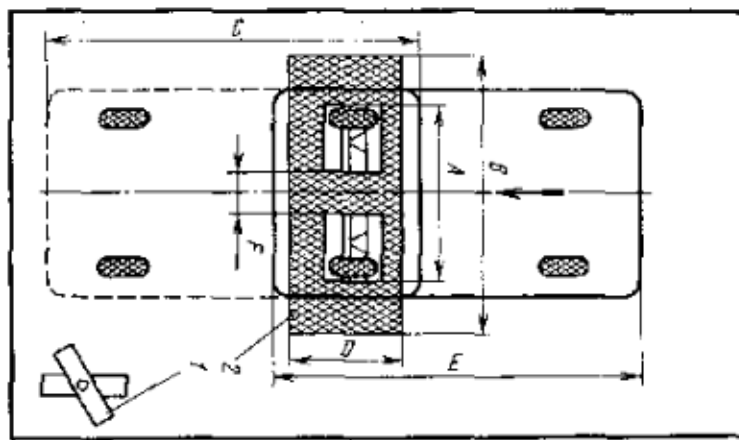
Планування майданчика із стендом для перевірки гальм:
